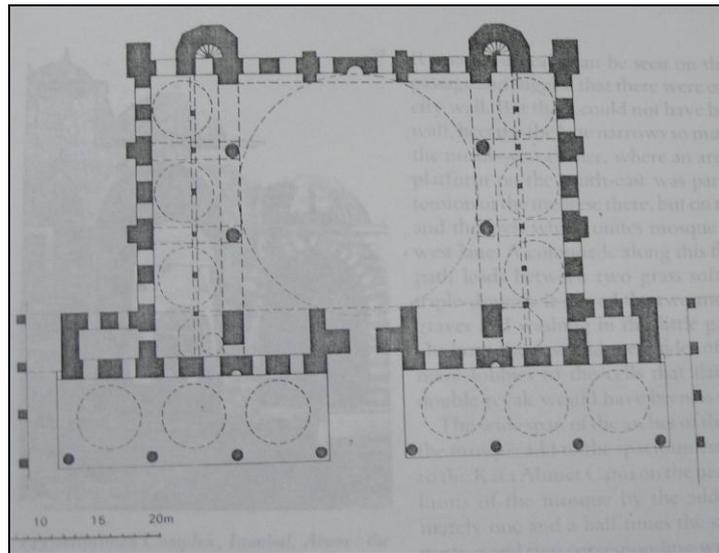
المسقط الأفقي للجامع الأخضر بأزنيق
